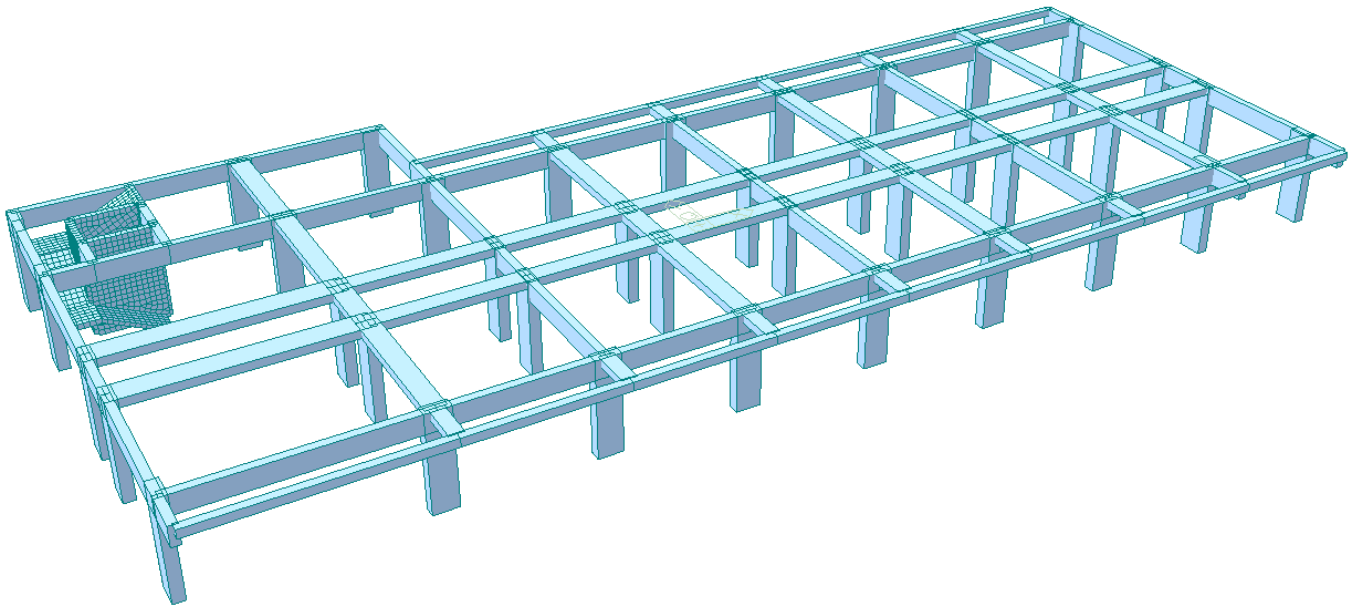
Modello FEM: vista tridimensionale estrusa del piano primo
